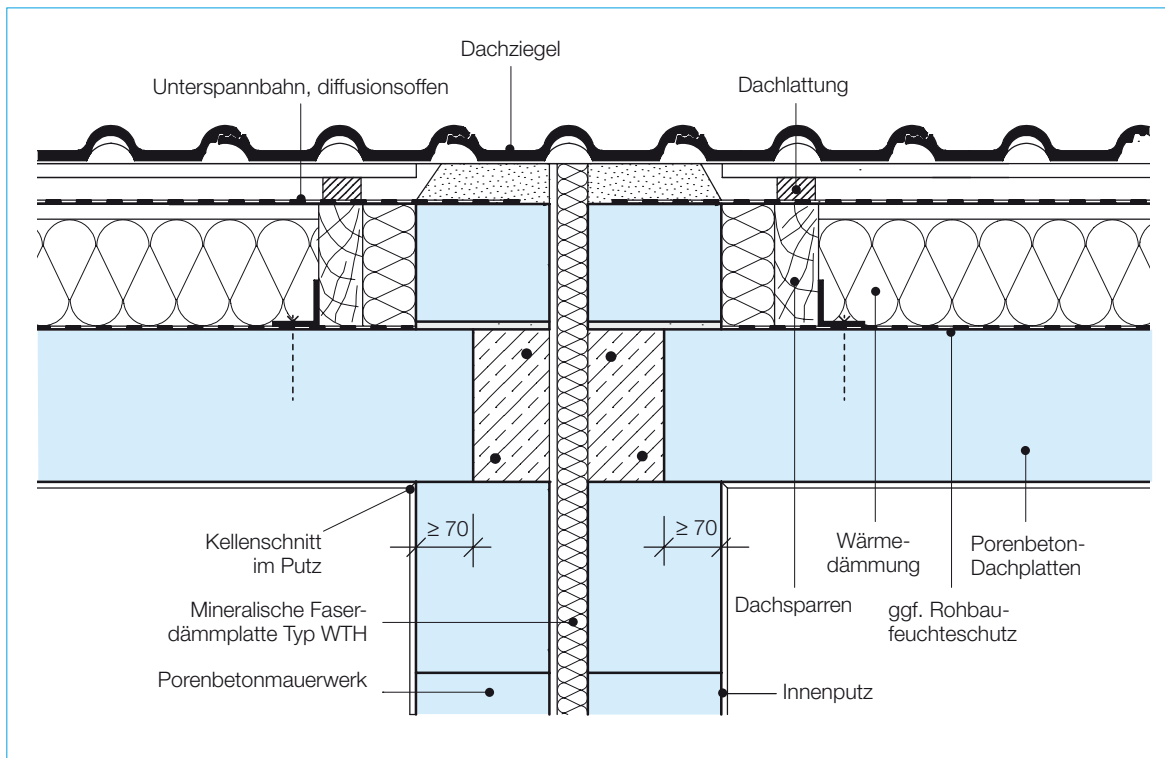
Zwischenauflagerung von Porenbeton-Dachplatten auf zweischaliger Haustrennwand aus Porenbetonmauerwerk (Ringanker unterhalb der Dachplattenebene)
